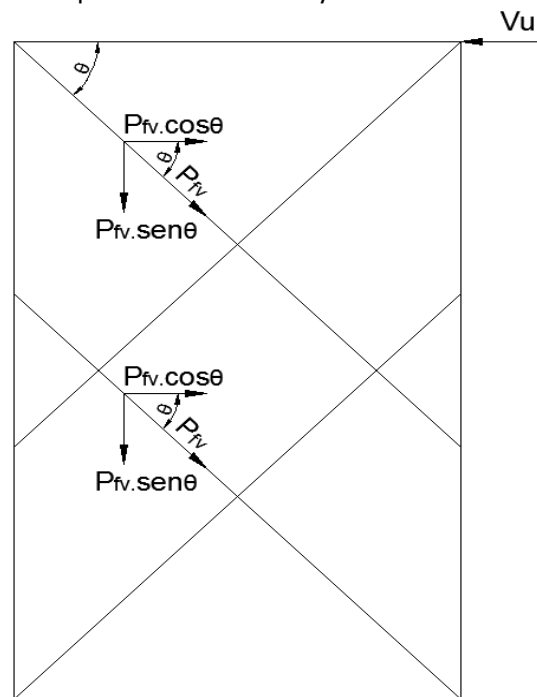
Descomposición de fuerzas que resisten el corte y la flexión.
